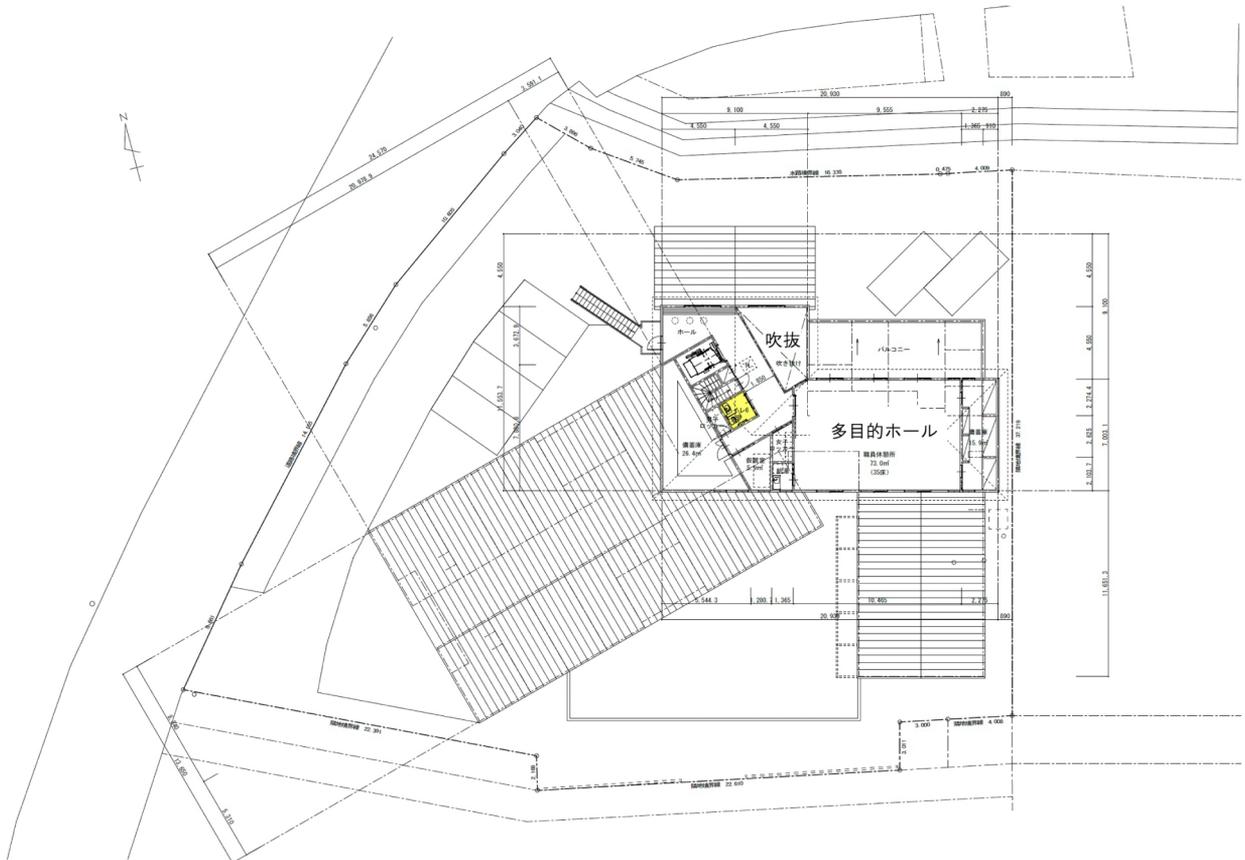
増築棟2階平面図 (基本設計案 2021.06.15)
